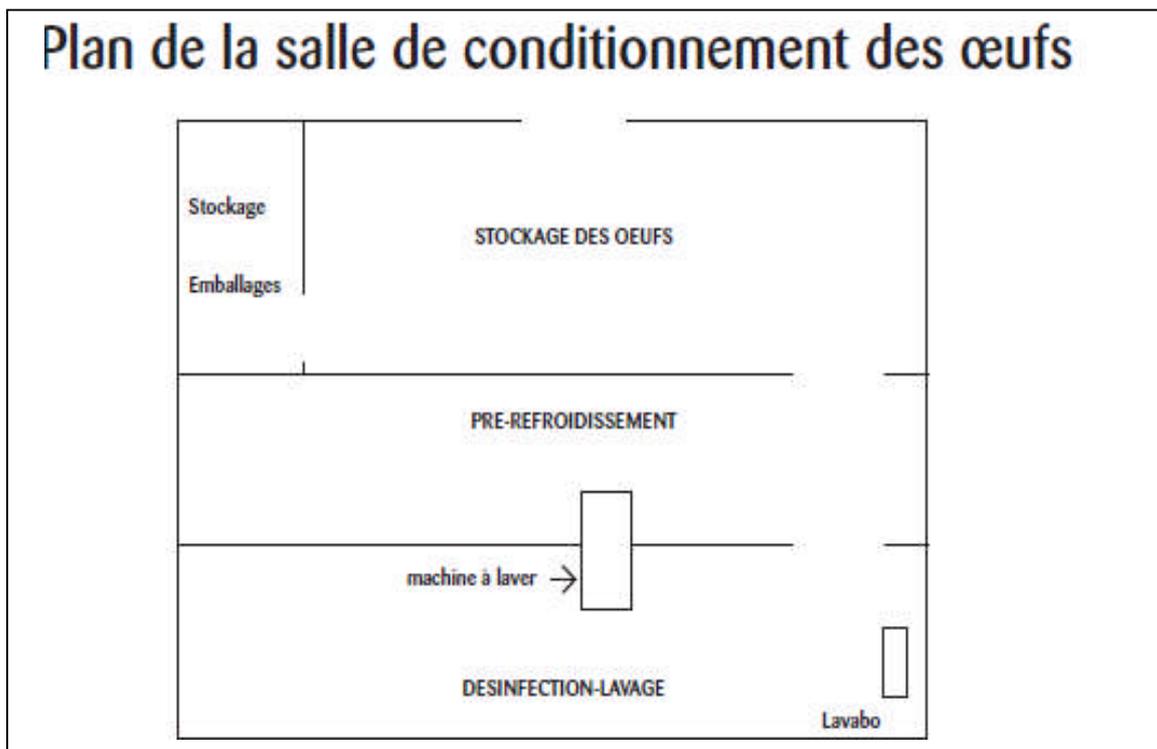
Plan de la Salle de conditionnement des œufs (Aviagen,2013)
